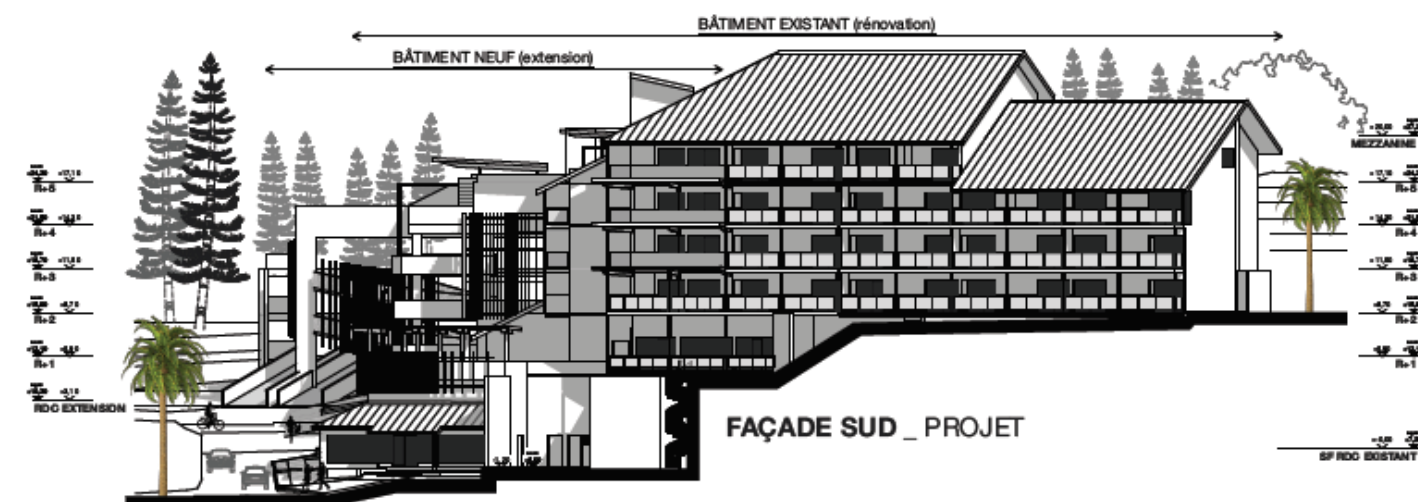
Façades Sud (Source : PC février 2020 – ARCHI 13)
